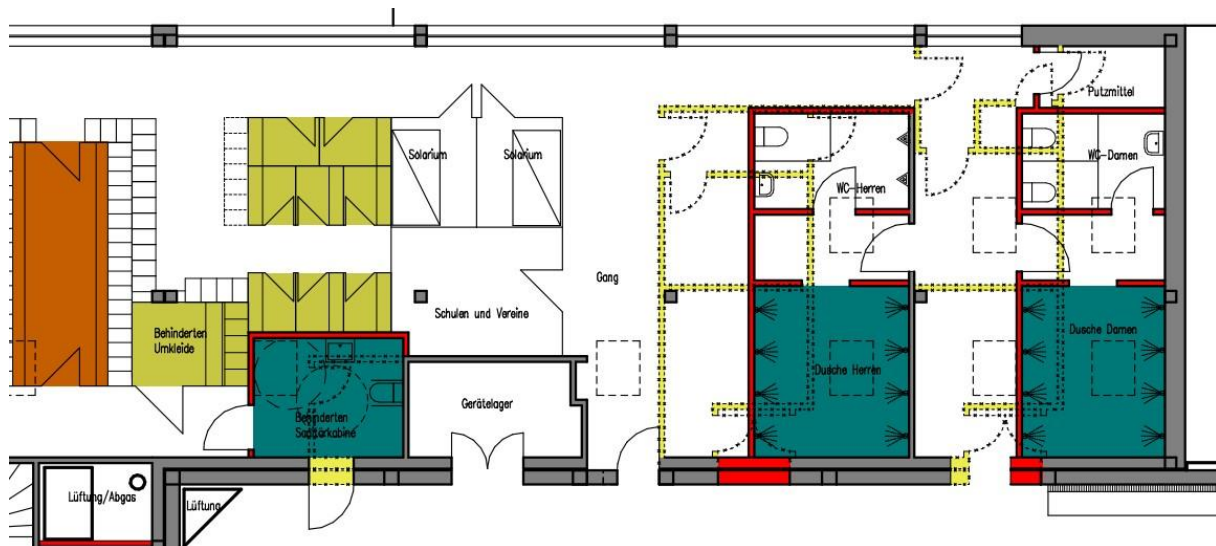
Grundriss mit sanitären Anlagen EG
